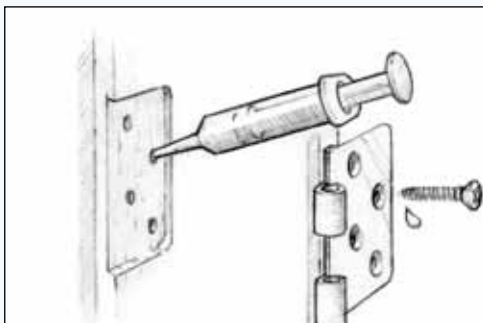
Pre-encole un taladro piloto de tamaño estándar e instale la fijación.
